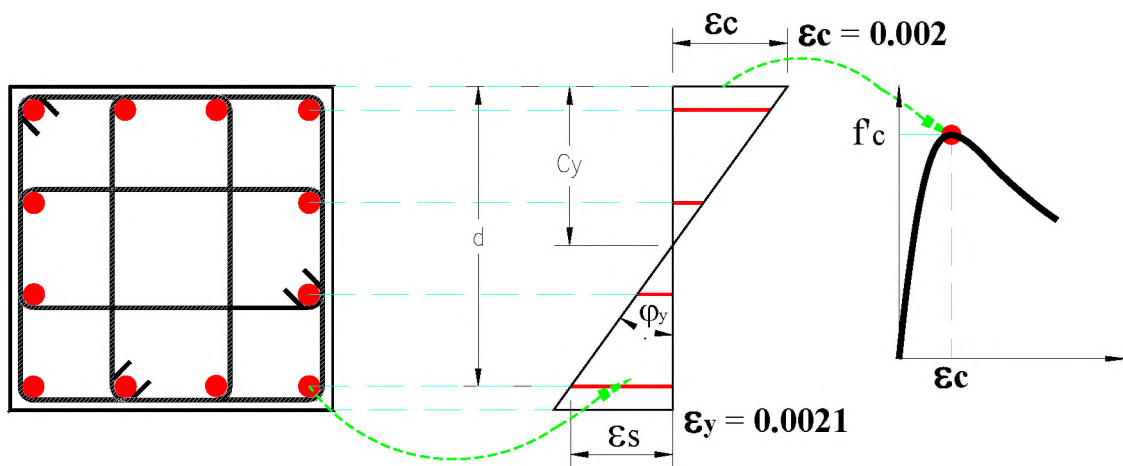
Estado límite de primera fluencia del refuerzo
